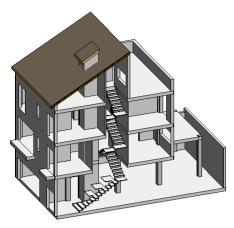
Elementos estructurales interiores. 2014. Elaboración propia.
